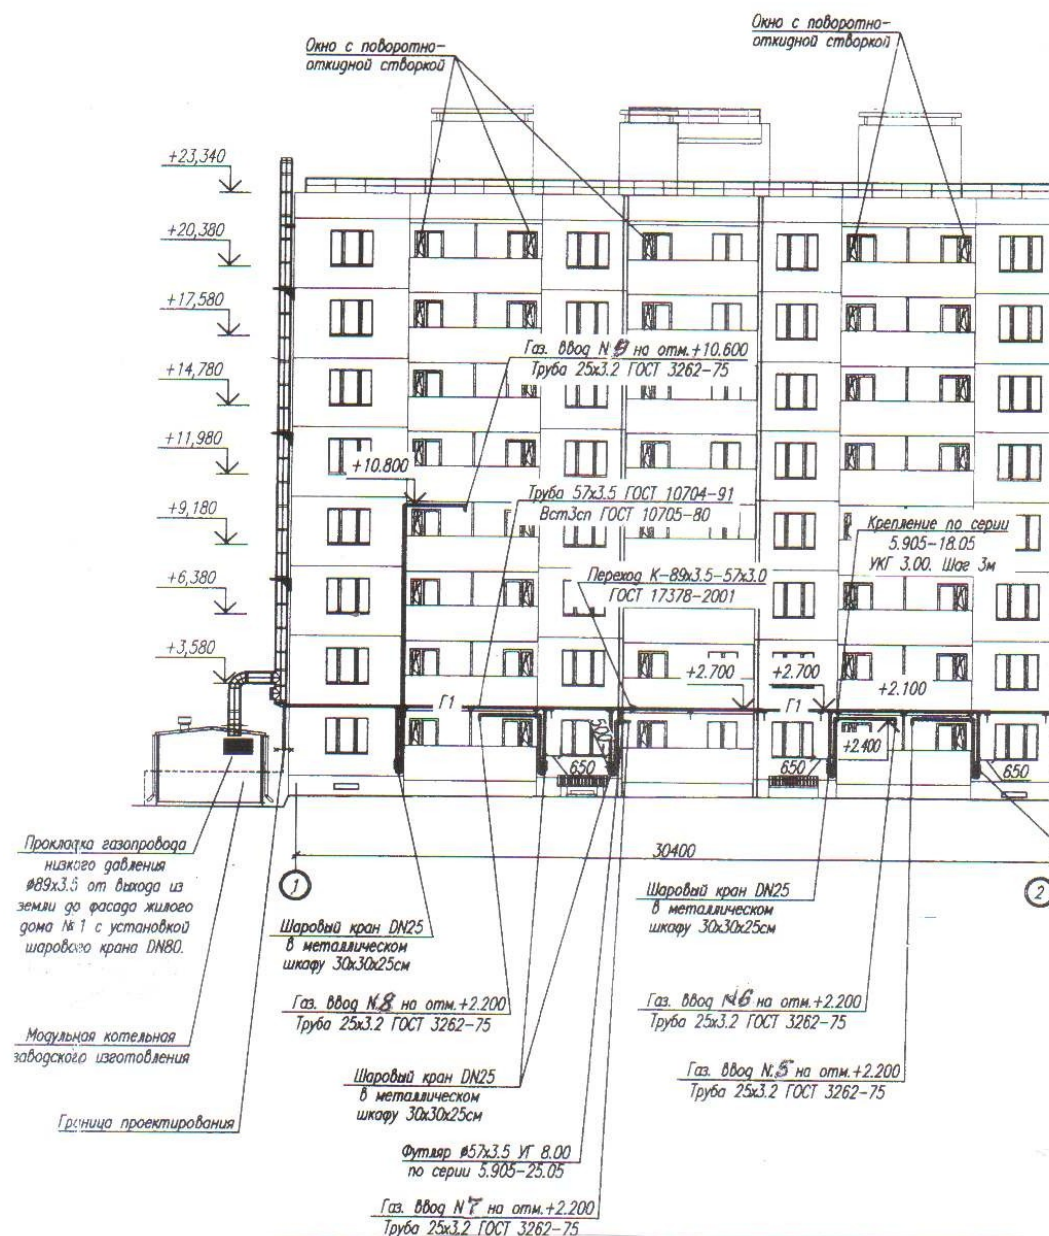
Прокладка газопровода по фасаду в осях 1-2
